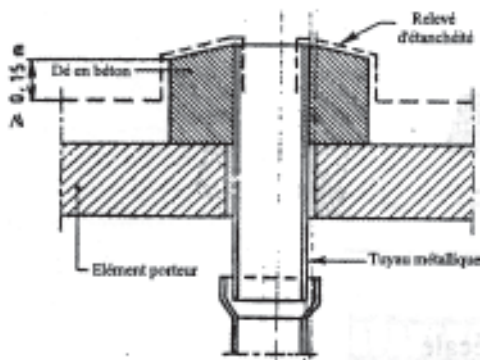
Traversée de canalisation métallique à travers un dé en béton
